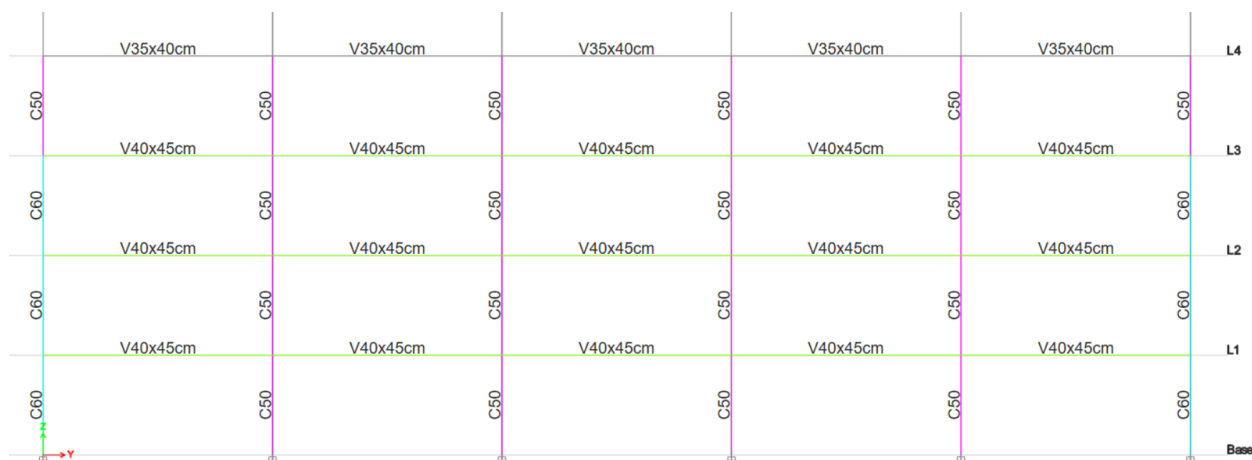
Configuración de las secciones en un pórtico exterior en dirección “y” para un edificio de 4 pisos para $\Delta_M = 2.0\%$.
